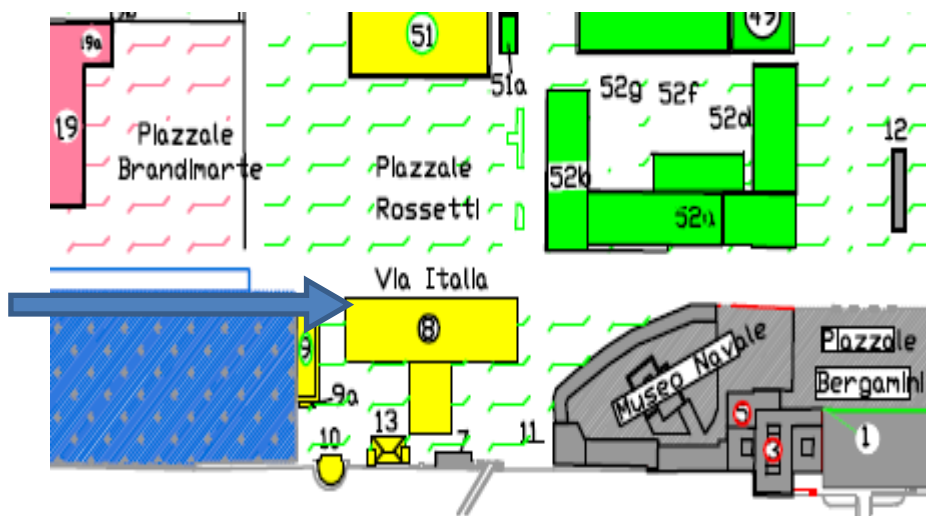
Planimetria Arsenale con indicazione Fabbricato n.8
